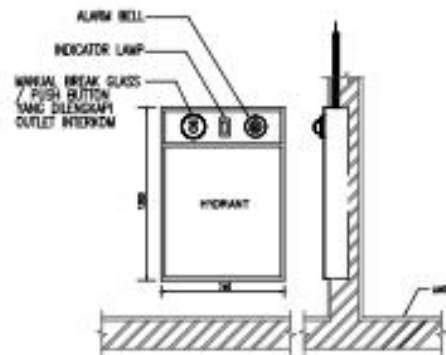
DETAIL INSTALASI FIRE ALARM PADA PLASTER
